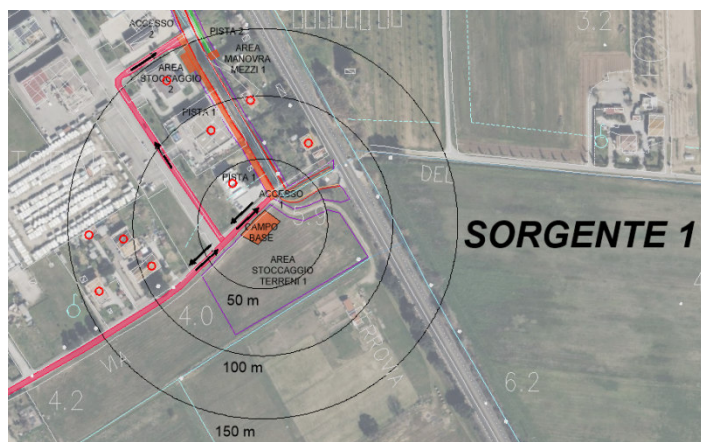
Estratto di tavola PGO\_01 Planimetria\_cantierizzazione
